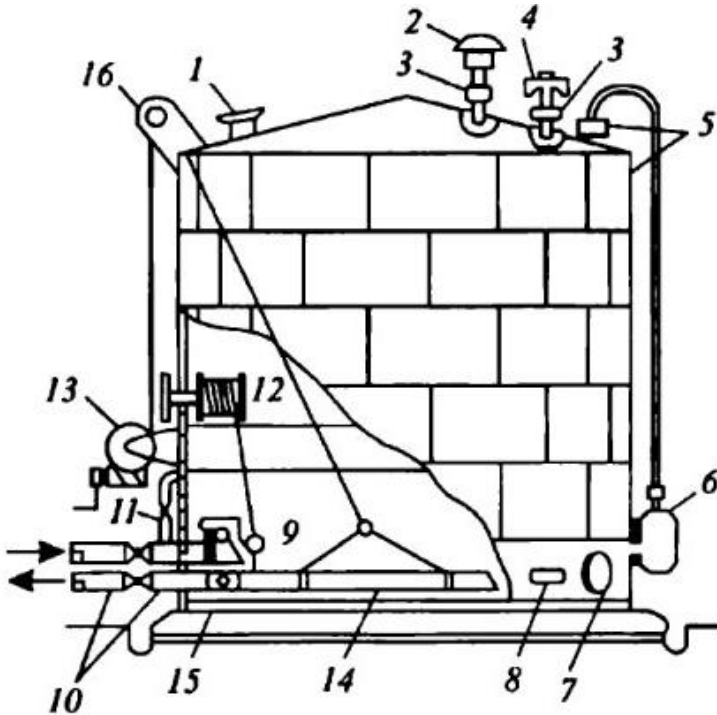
Циліндричний вертикальний резервуар із конусною покрівлею:
